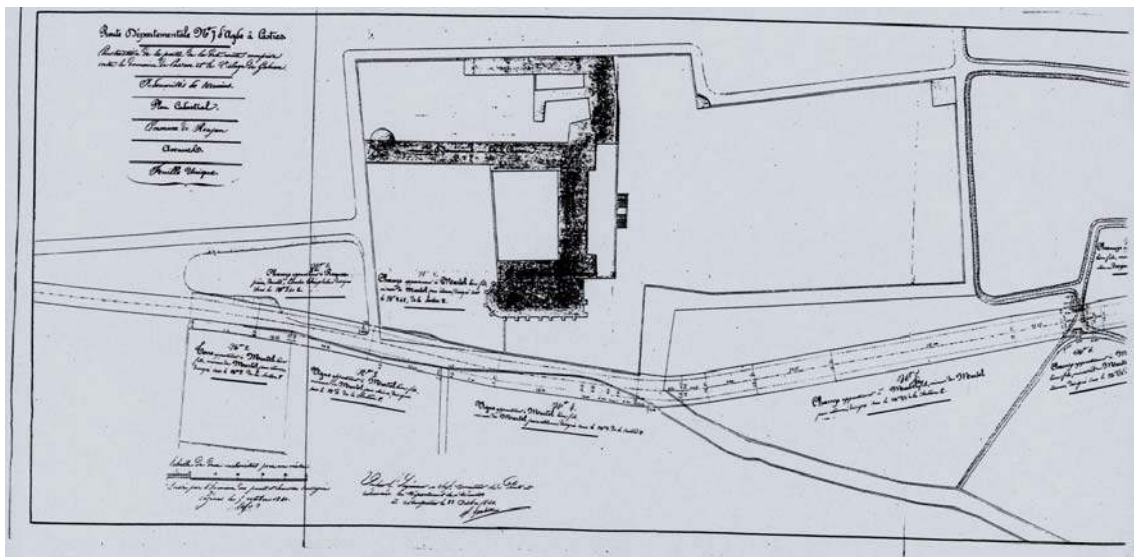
Extrait du plan de la construction de la Route départementale n° 7 d'Agde à Castres, comprise entre le Domaine de Cassan et le village de Gabian, dressé en octobre 1840 par Maffre, Ingénieur des Ponts et Chaussées à la résidence de Pézenas. (ADH - 2 S 1088).
